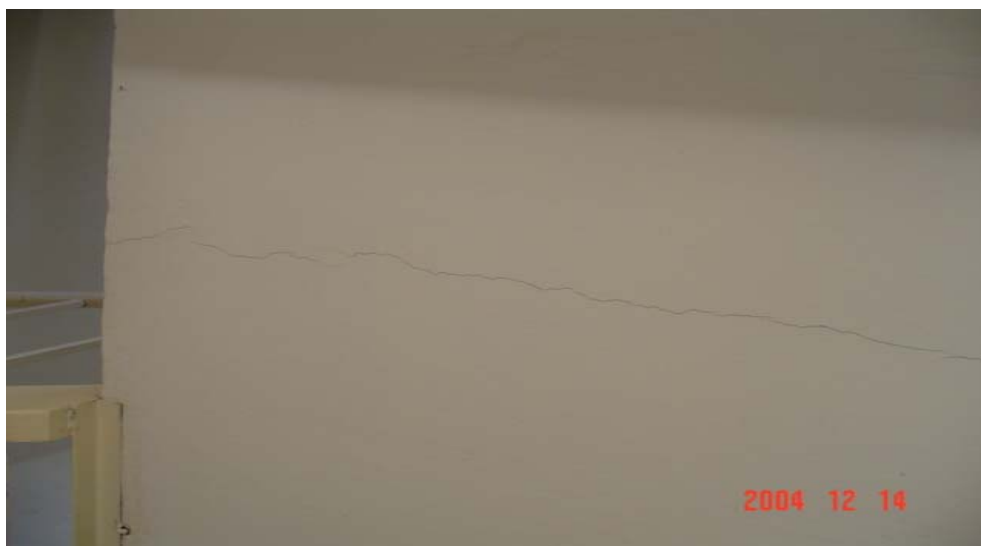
fissura do tipo “b”, na face inferior da laje junto ao recorte para o vão da escada. Condomínio Pôr do Sol.
